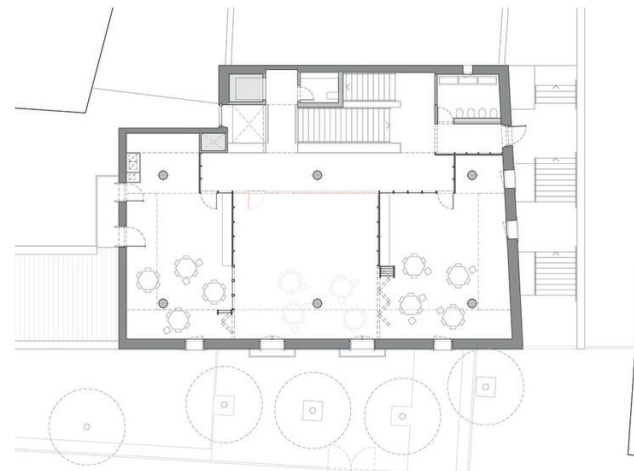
Can Rosés Temporary School, Grundriss
